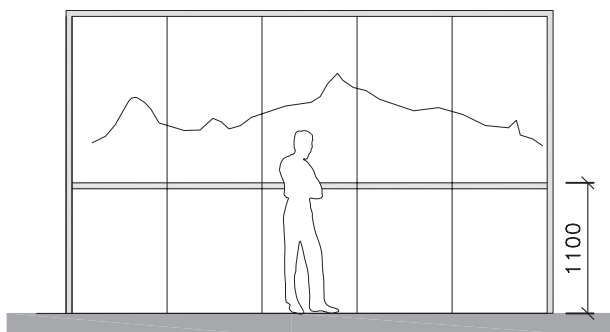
Zorný úhel pohledu oken se sníženým parapetem – A) snížený parapet, B) ochranné zábradlí, C) zóna umístění kliky okna, pákového uzávěru
